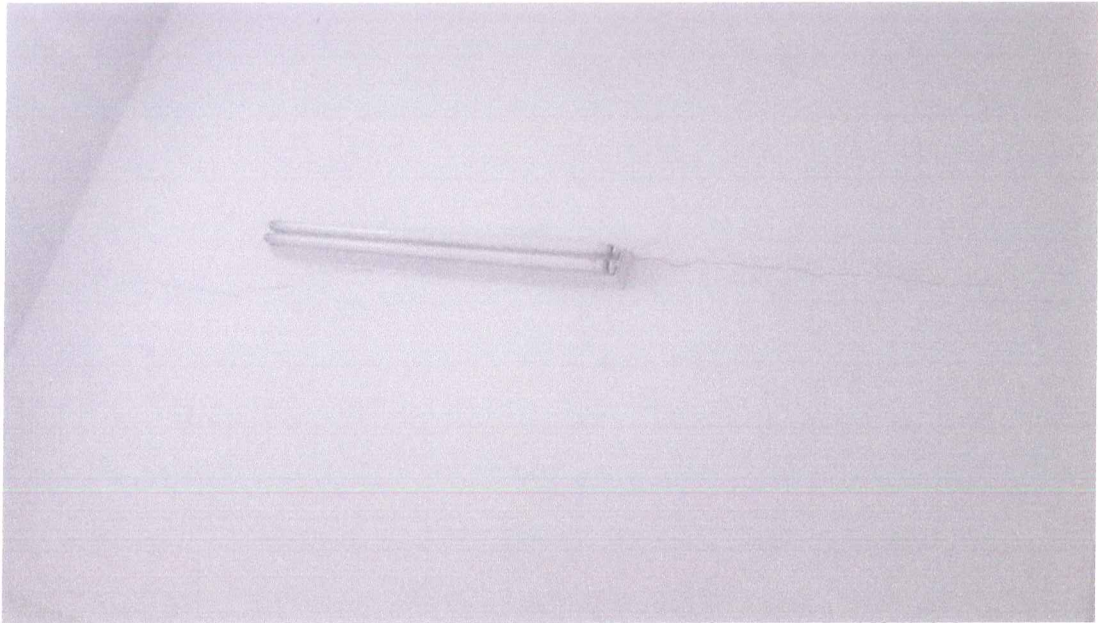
LAJE DA UNIDADE APRESENTANDO FISSURAS
